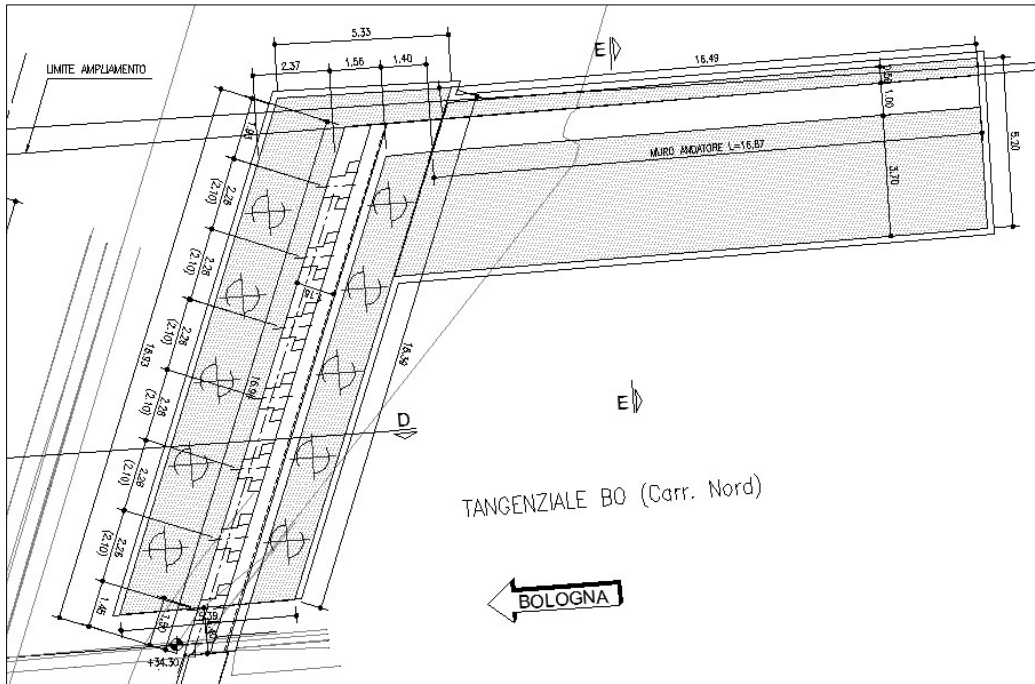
Posizione planimetrica del muro andatore lato Rimini - Allargamento Nord
